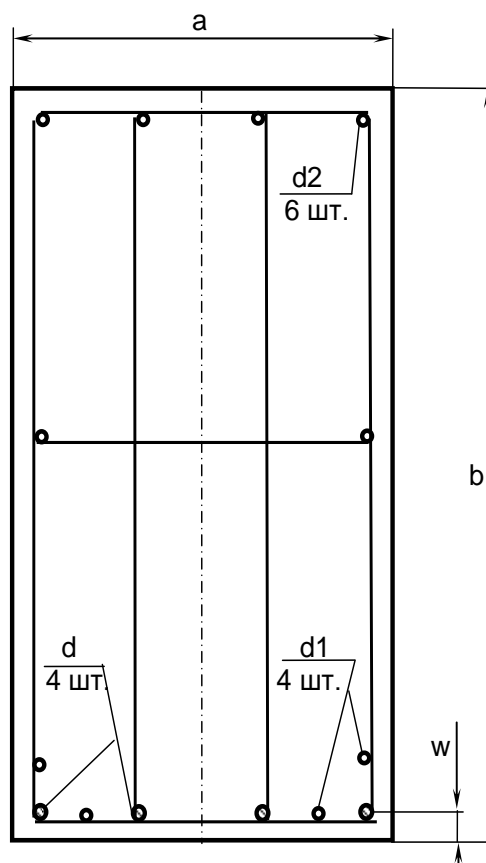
Схема розташування та діаметри арматури балки
